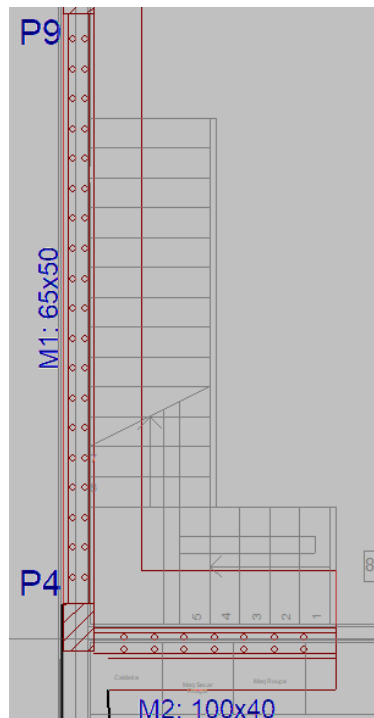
Muro já colocado (Fonte: CYPE)
